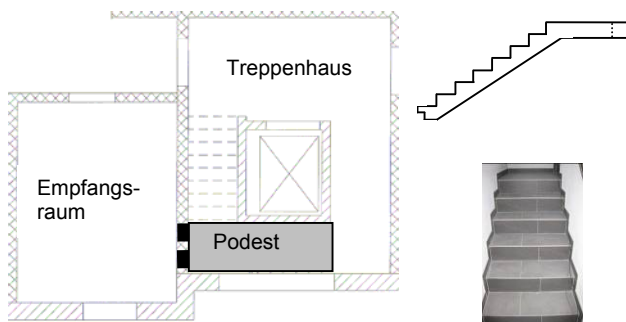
Grundriss der Übertragungssituation und Betonfertigteile: Podest mit 1,0 x 1,0 x 0,18 m und anbetoniertem 6-stufigem Treppenlauf; Entkopplung jeweils mit Schöck Tronsole AZ; Treppenwand: 24 cm KSV RDK 1,8 (wie im Prüfstand)
